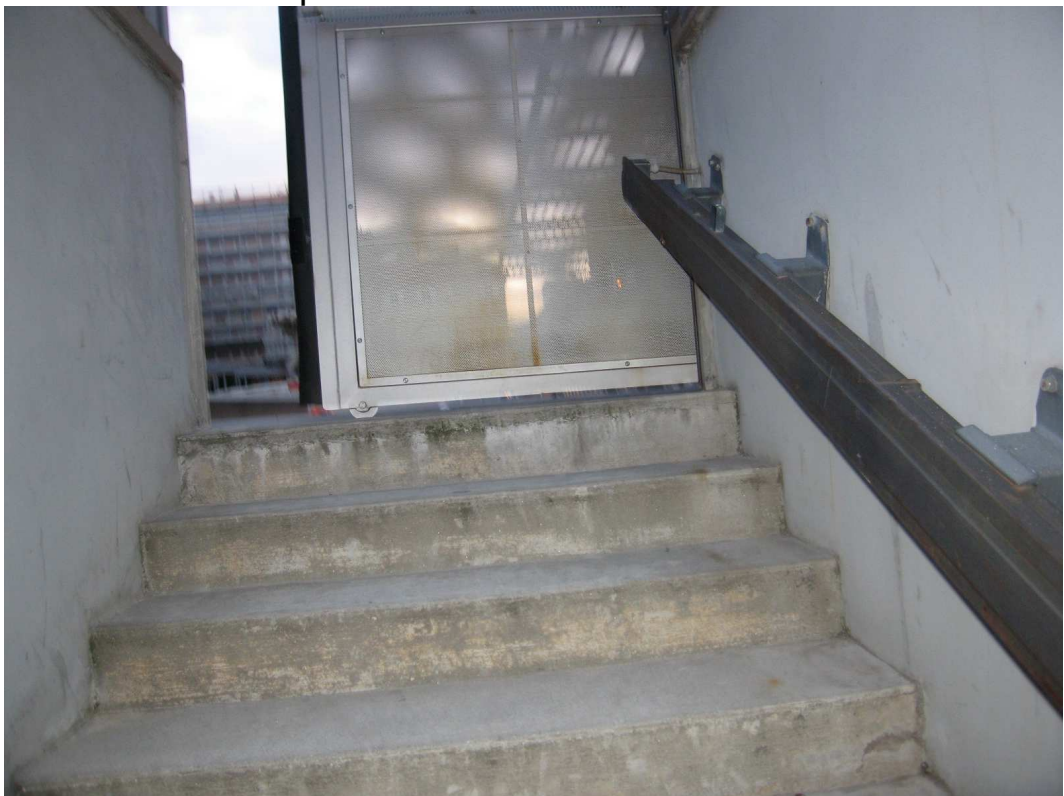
autorimessa di piazza Vittorio Veneto, box auto ente "80" particolare basculanti
